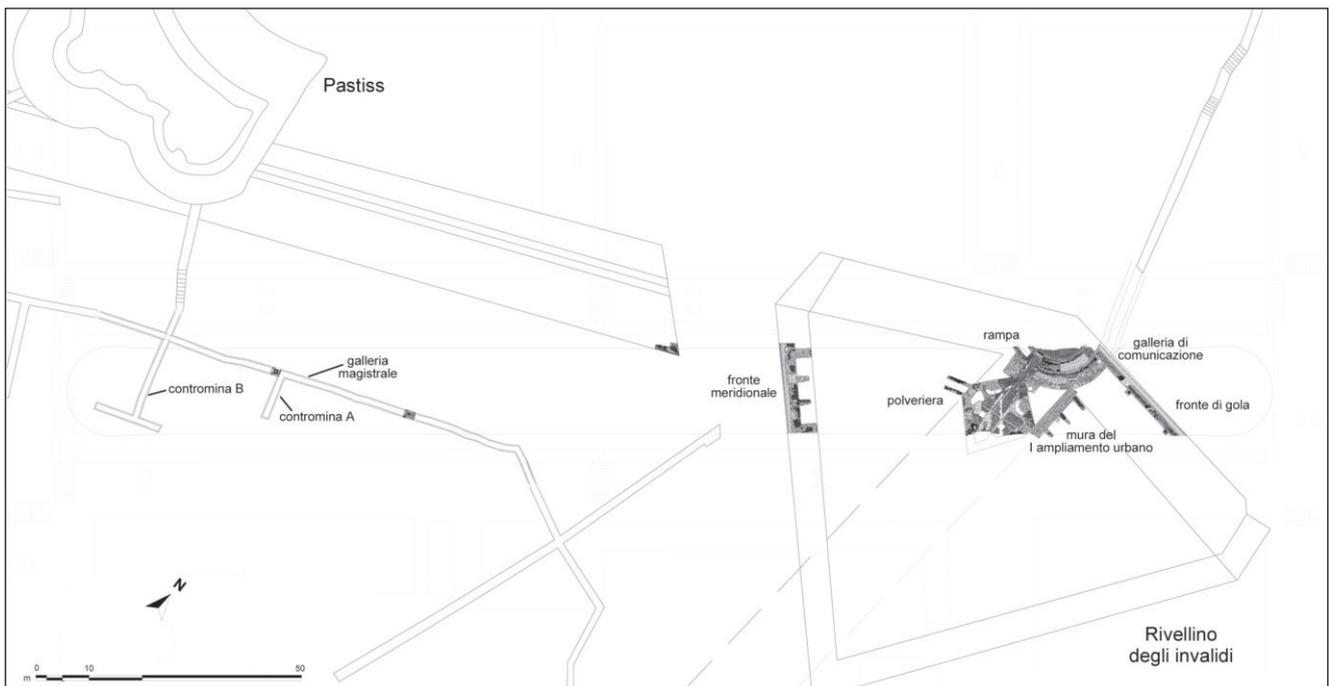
Planimetria generale dell'area di scavo (elab. S. Di Silvestre).
